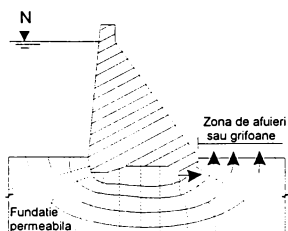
Baraje din beton. Zona de sufozii și afuieri.
